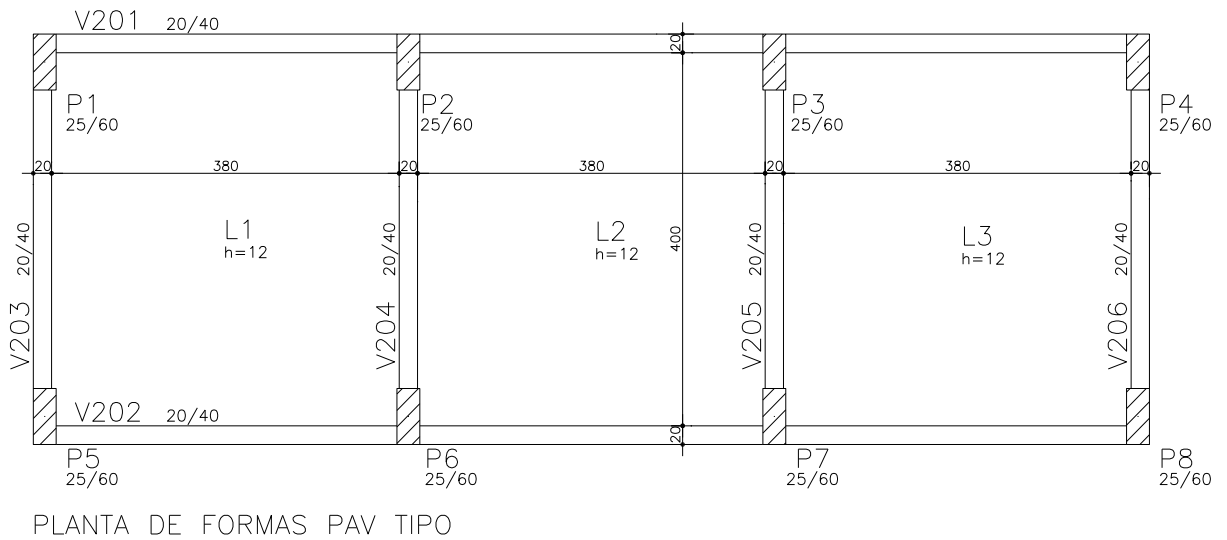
Planta de formas do pavimento tipo: T1 -5P2V1
